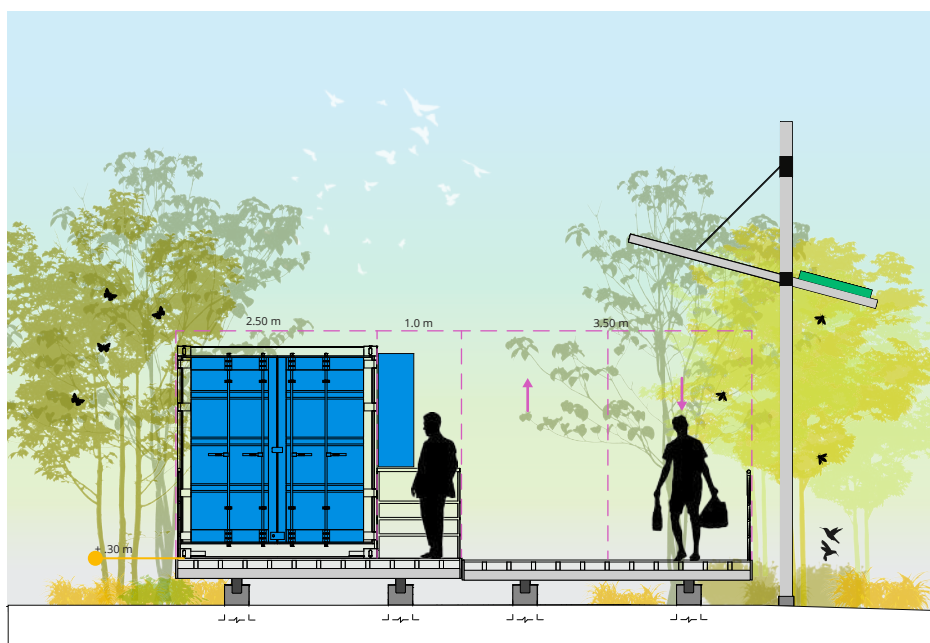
Propuesta sendero elevado. Fuente: Elaboración propia.
